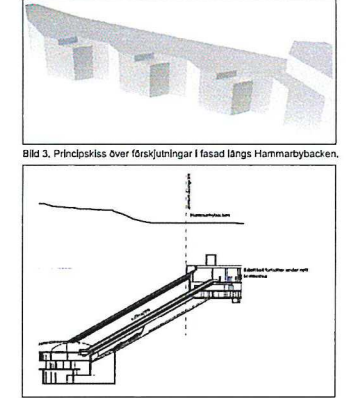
Principsektion genom Hammarbybacken som visar tunnelbaneanläggningens ungefärliga placering.
